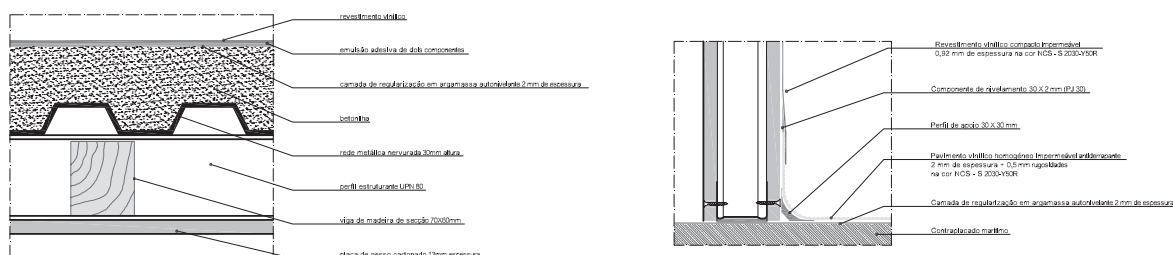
Pormenores de aplicação do vinílico na casa de banho, sobre a laje a construir e a laje existente (consultar apêndice 3).
